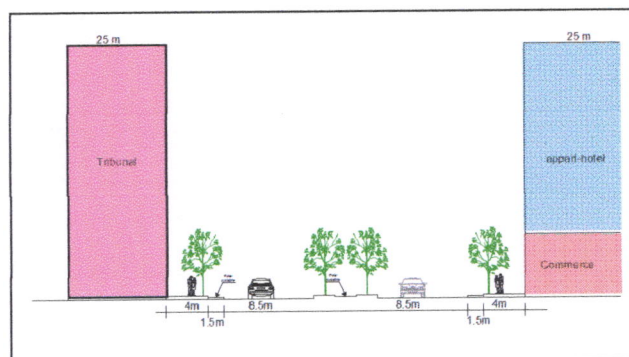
Coupe sur voie principale.(nord-sud)
